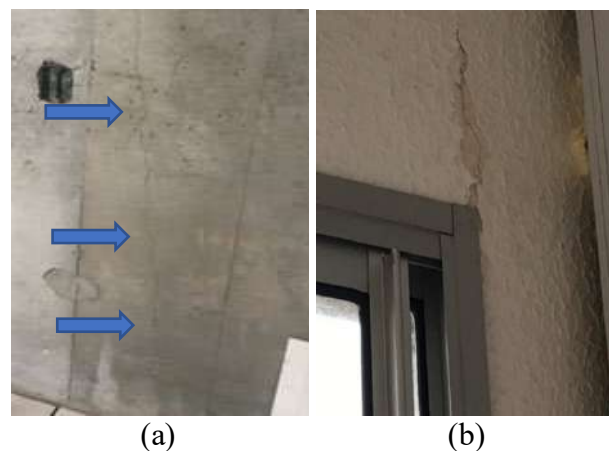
Fissura ao longo da extensão de parede de concreto (a) e fissura no canto superior de janela de parede de concreto (b), ambas na Obra A.
